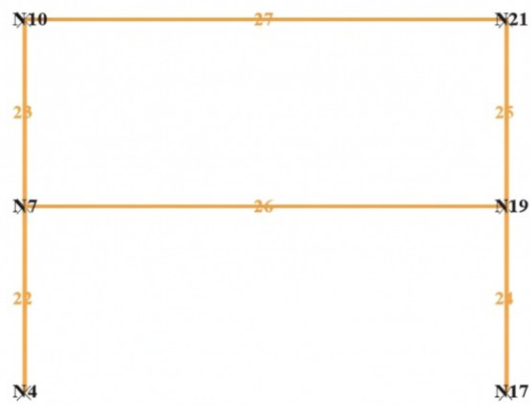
Prospetto Parete Fittizia 4 - Modello Scollegato
